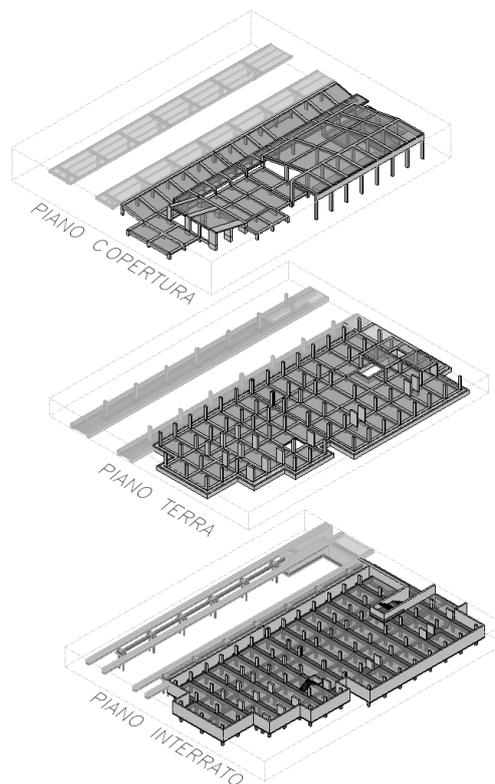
Vista assometrica del Fabbricato oggetto di intervento – Livelli
